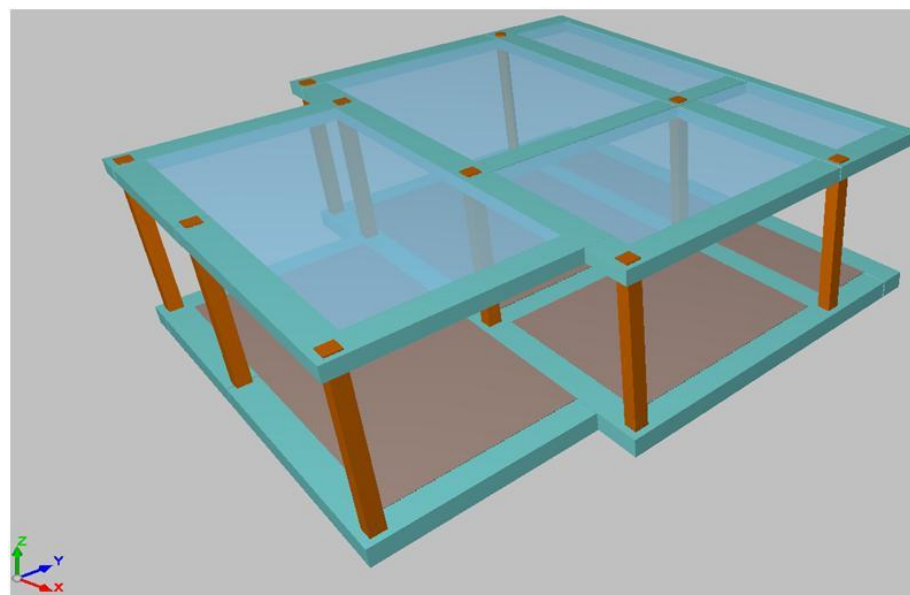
Vista 3D del modelo estructural del Edificio de Control
